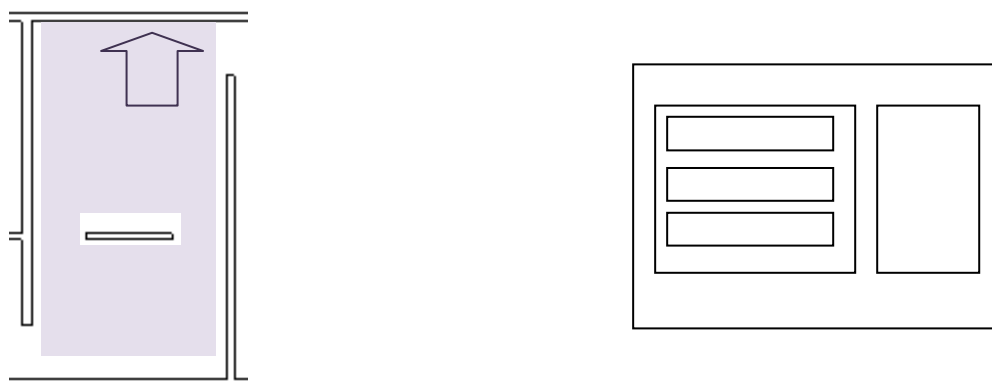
Módulo Mão de obra. Planta baixa e elevação esquemática da parede 05.
